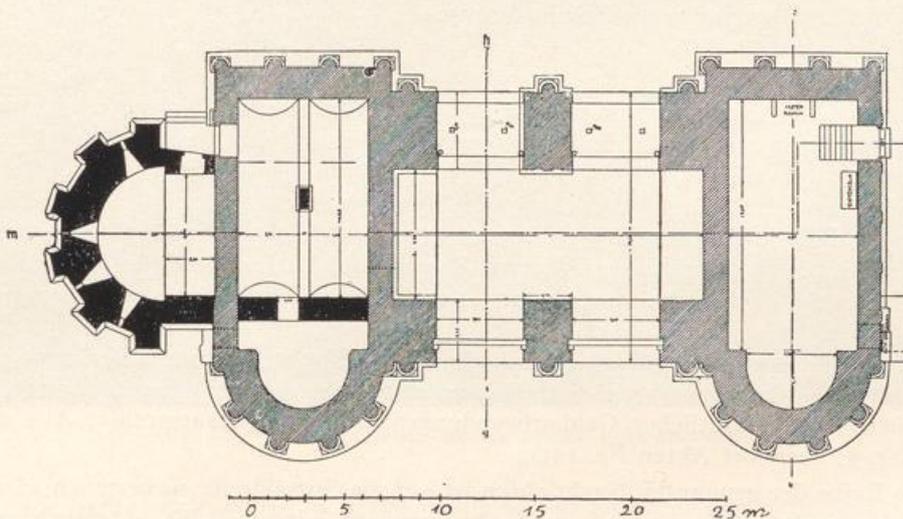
Porta Nigra und Simeonschor. Grundriß des Erdgeschosses.
